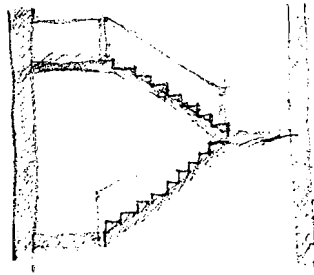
Bentuk dan Ruang Sirkulasi
